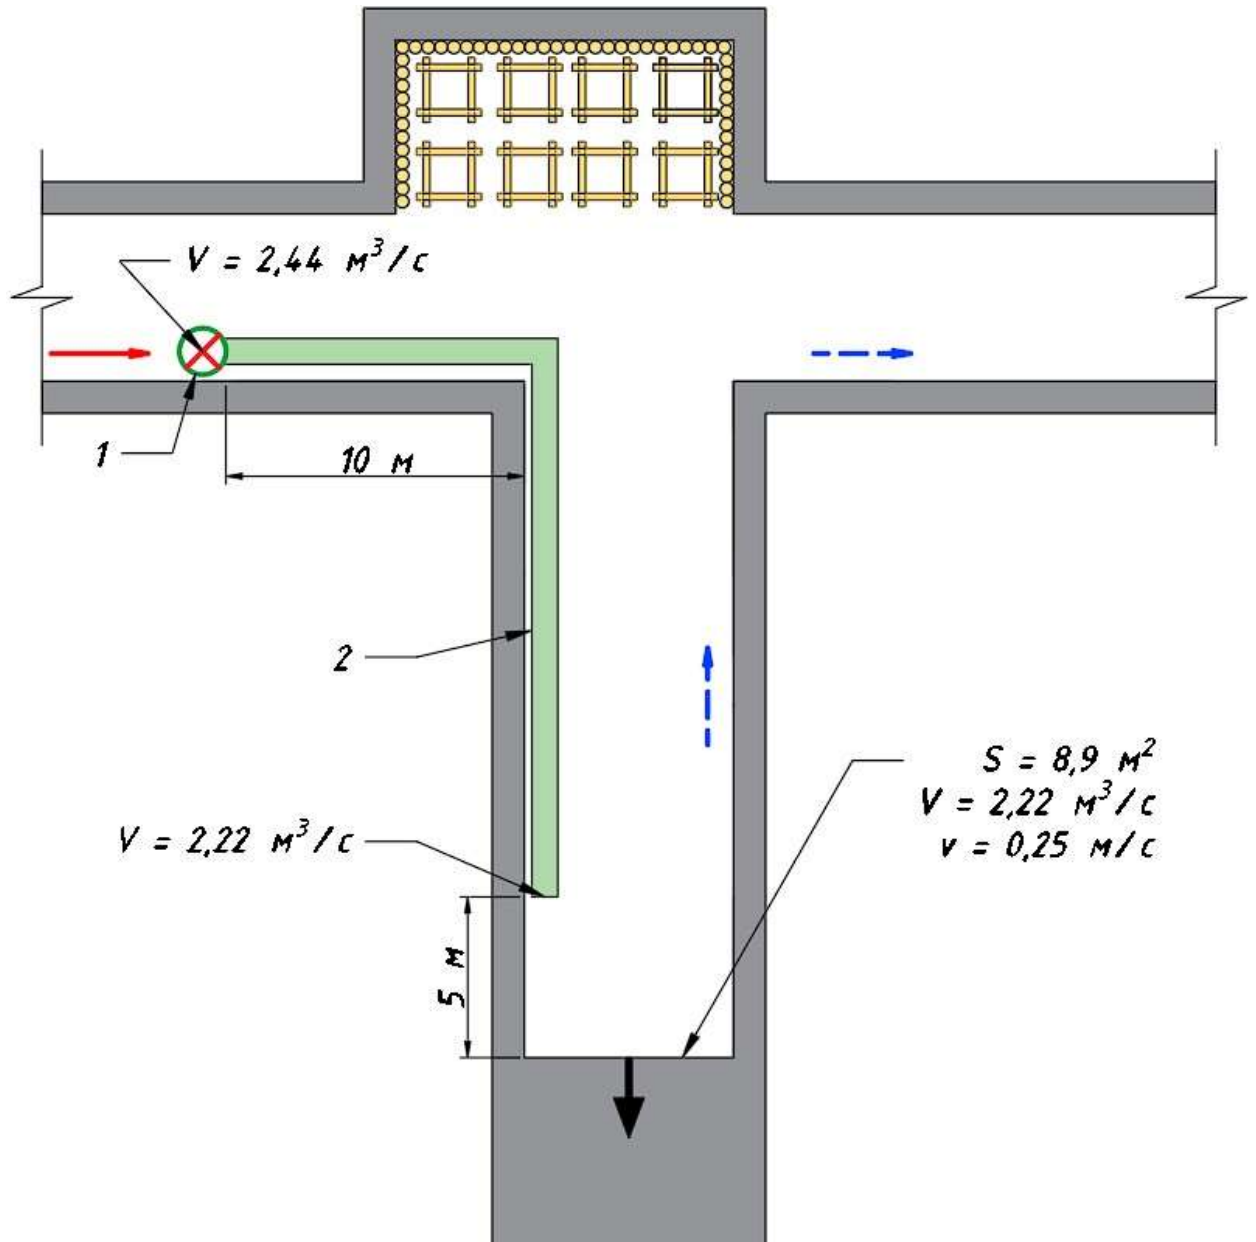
Схема проветривания проводимой выработки на первом этапе проведения: 1 – вентилятор местного проветривания; 2 – вентиляционный трубопровод
